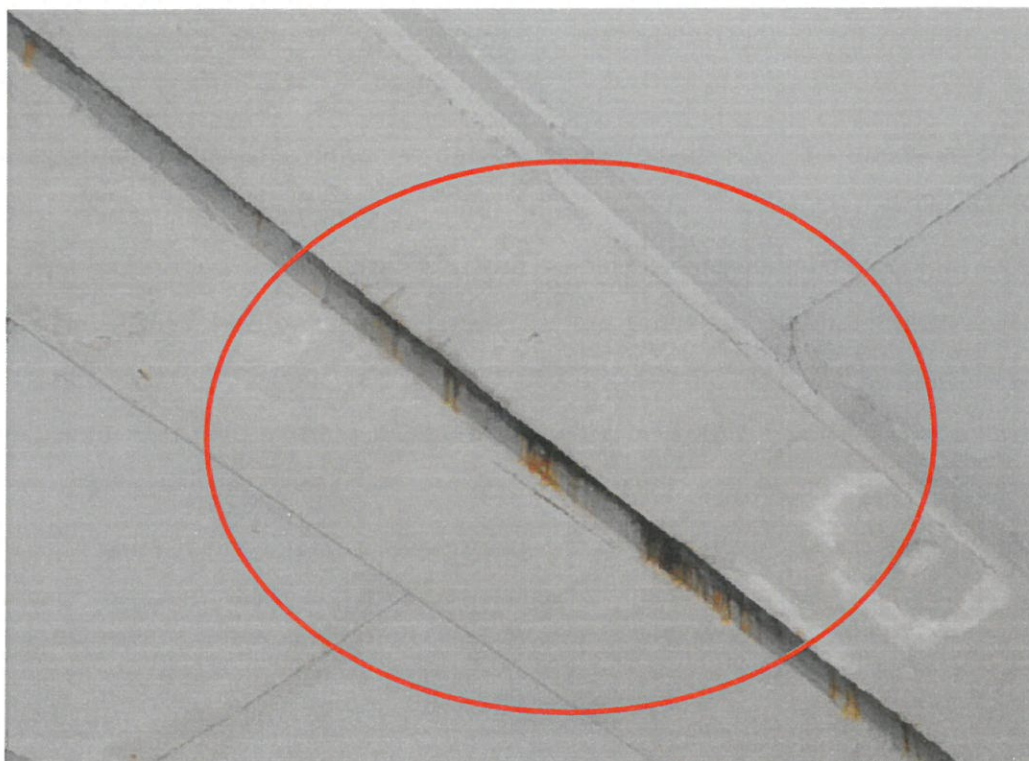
Podłużna rysa elementu uciągającego przęsła, ubytek betonu, korozja zbrojenia (oczep, podpora 7 Pd)
